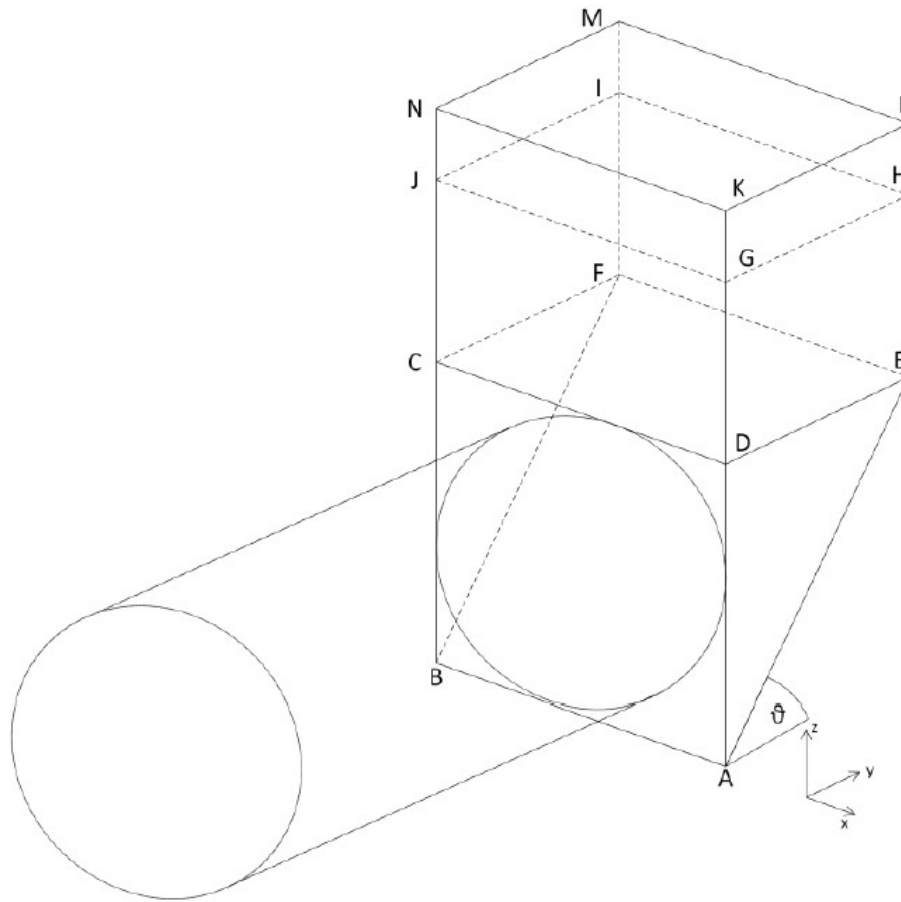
Hraniční meze podpůrného tlaku [3]
